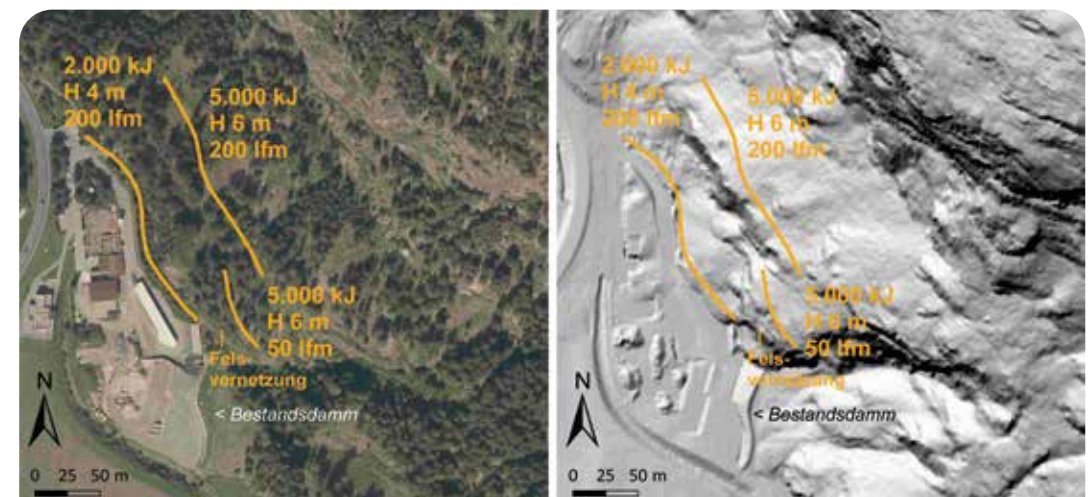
Situation im Lageplan (Orthofoto und LIDAR-Geländemodell) mit dem Verbauungskonzept nach Sausgruber (2015).
